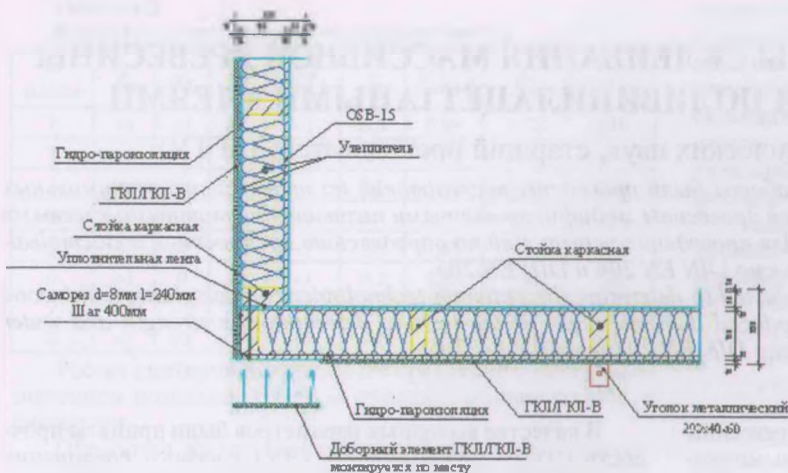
Угол углового крепления наружных стеновых панелей тип.2
